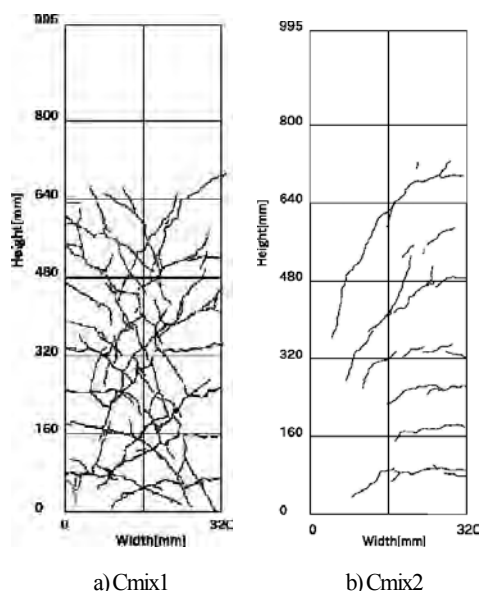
+4 δ yにおけるひび割れ進展状況
